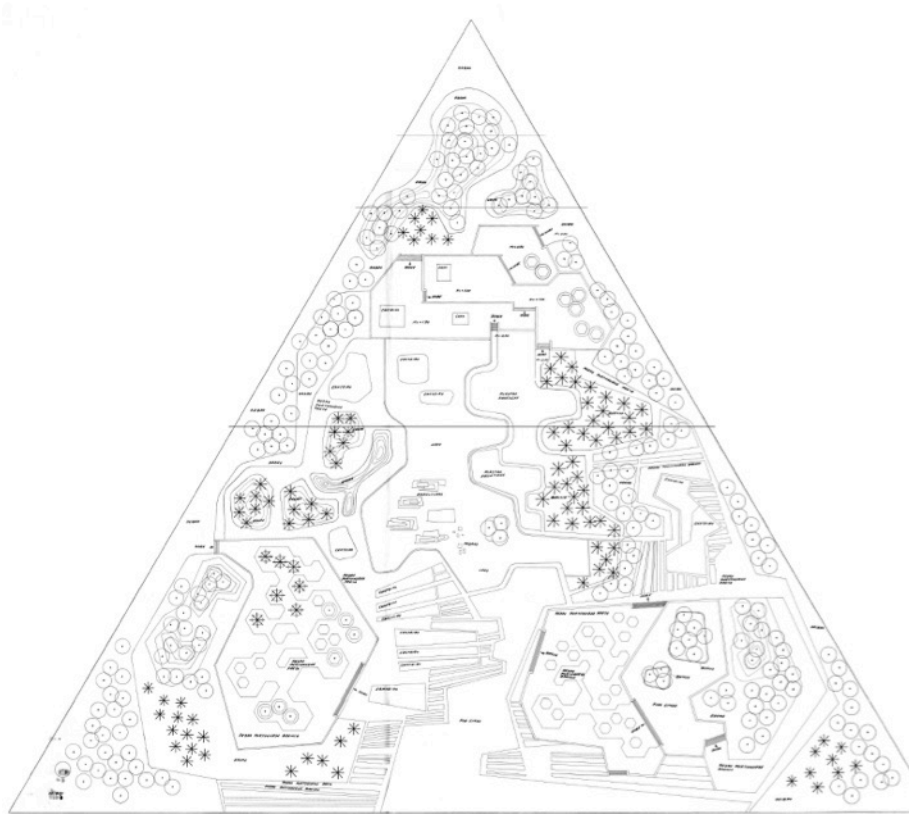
Planta Baixa da Praça dos Cristais. Fonte: Mapoteca CRO11
